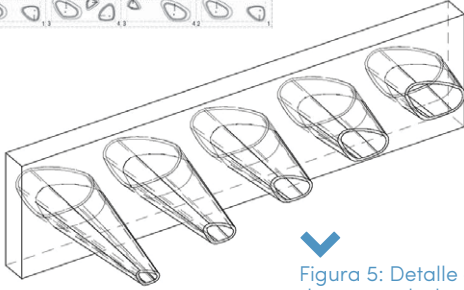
Detalle de la tipología de conos de la fachada occidental.
